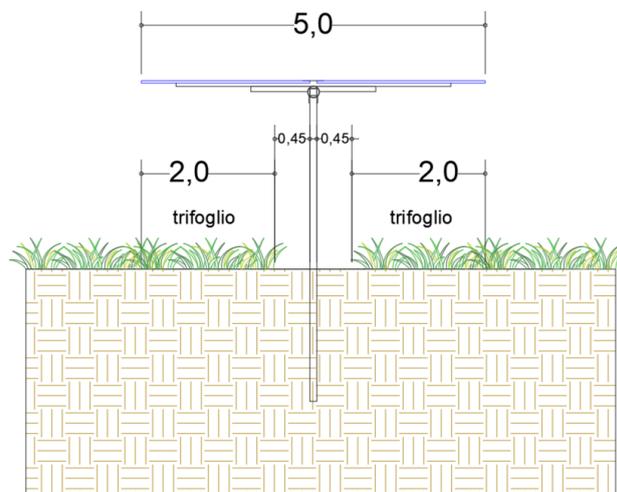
Area sottesa dal singolo modulo in posizione orizzontale.
